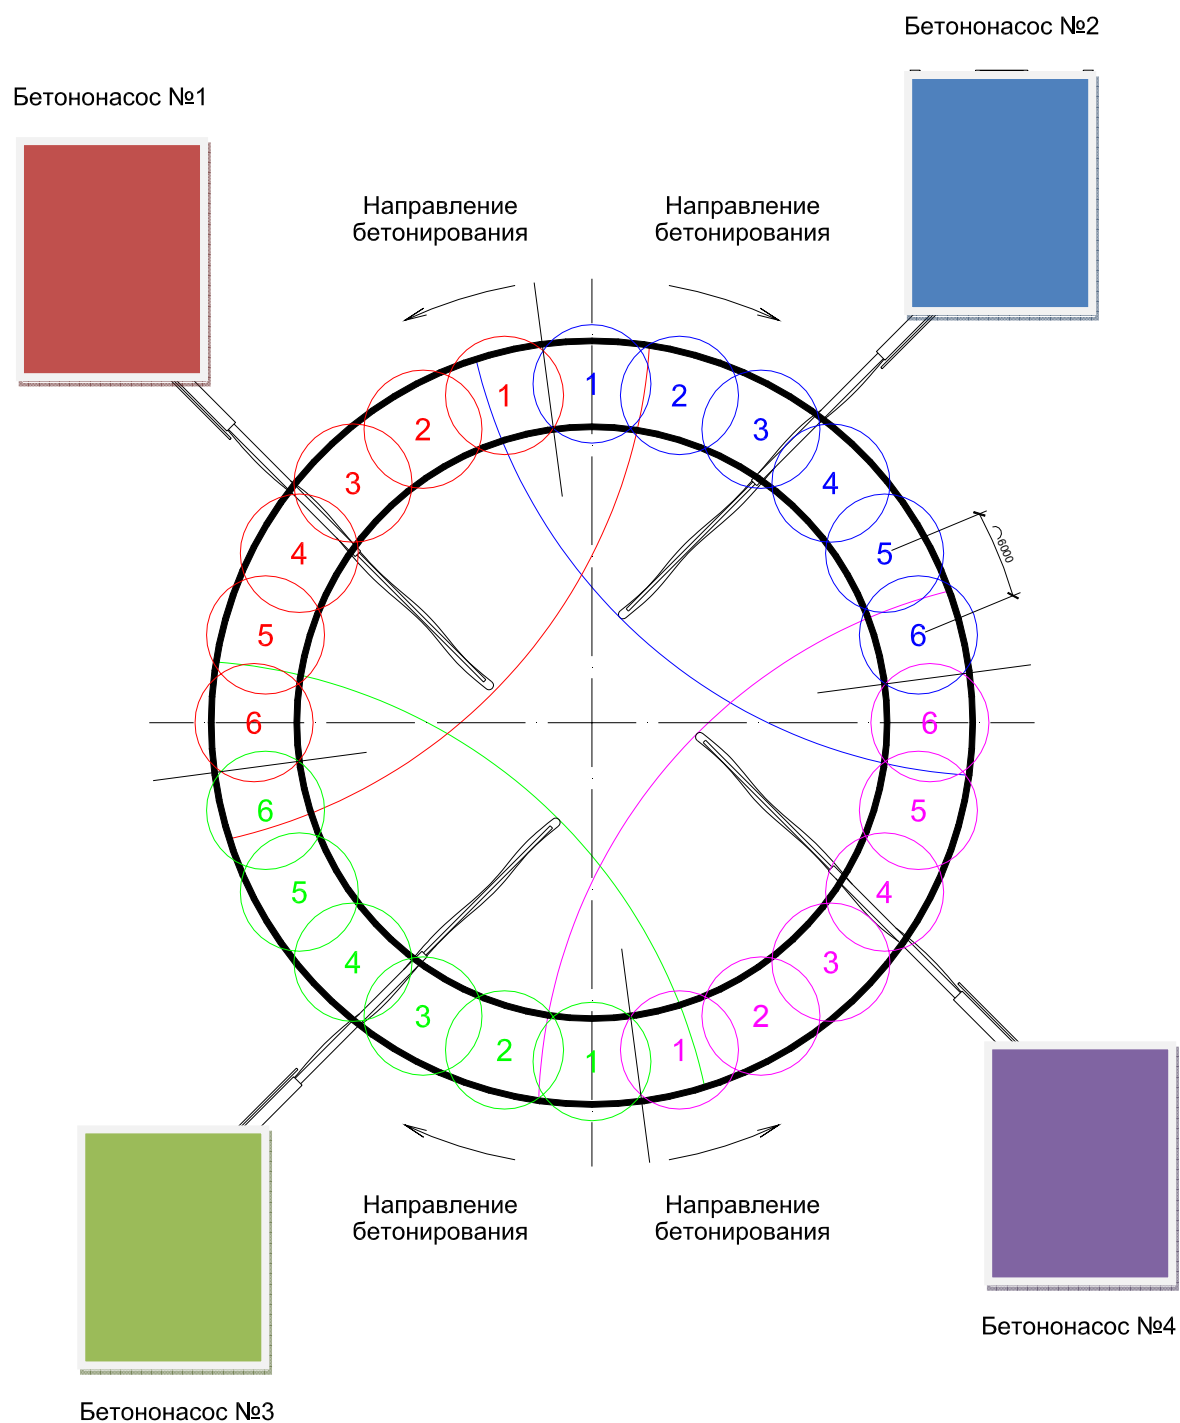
Схема укладки бетонной смеси в ярус бетонирования
